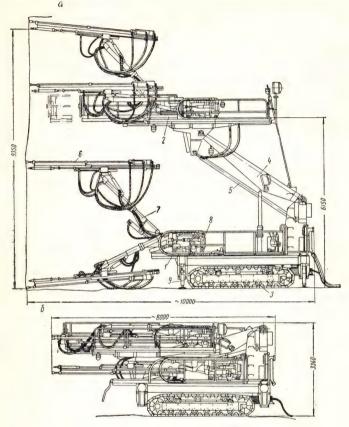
Буровая установка СБУ-4: а - в рабочем положении; б - в транспортном
